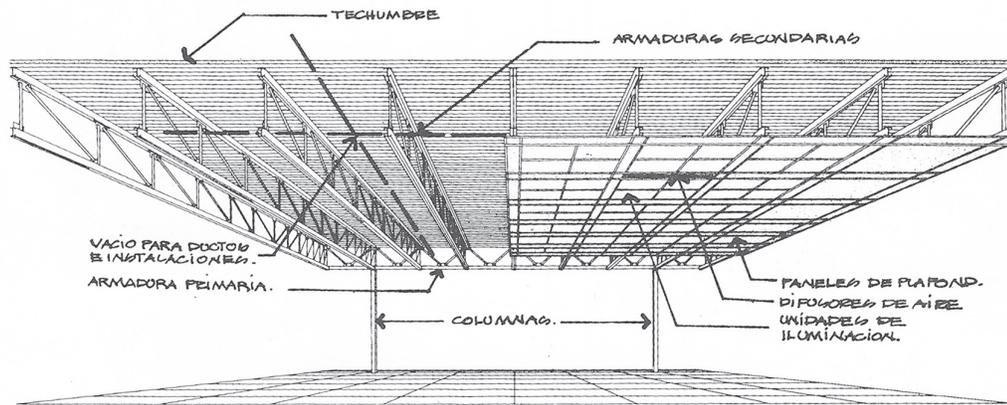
Sistema Constructivo Prefabricado SCSD.
